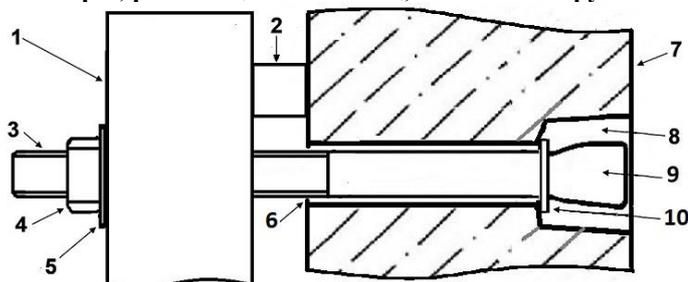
Крепление кронштейна типа ККП с опорным сухарём к вертикальной стене колодца ККСр с помощью ерша с резьбой:
